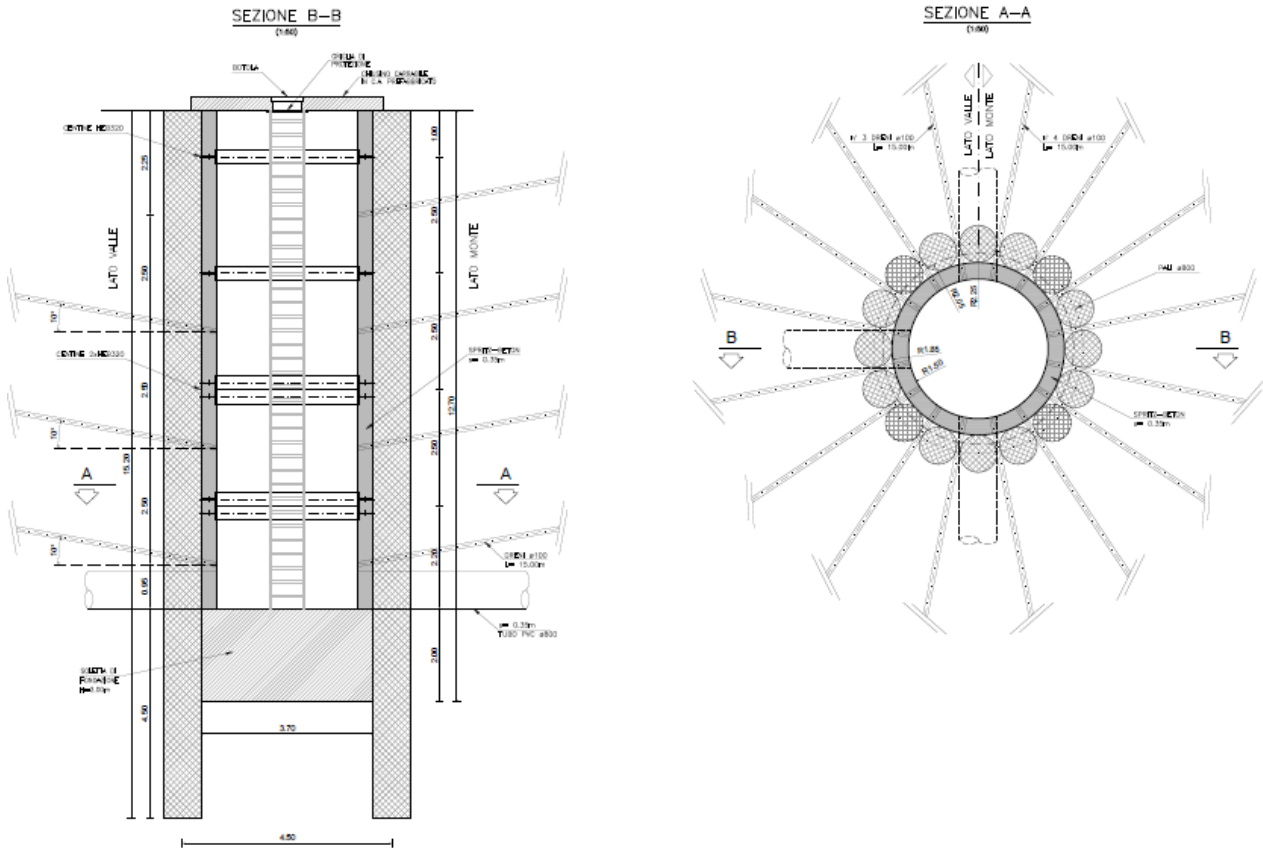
Sezione tipo intervento di stabilizzazione tramite pozzi drenanti
